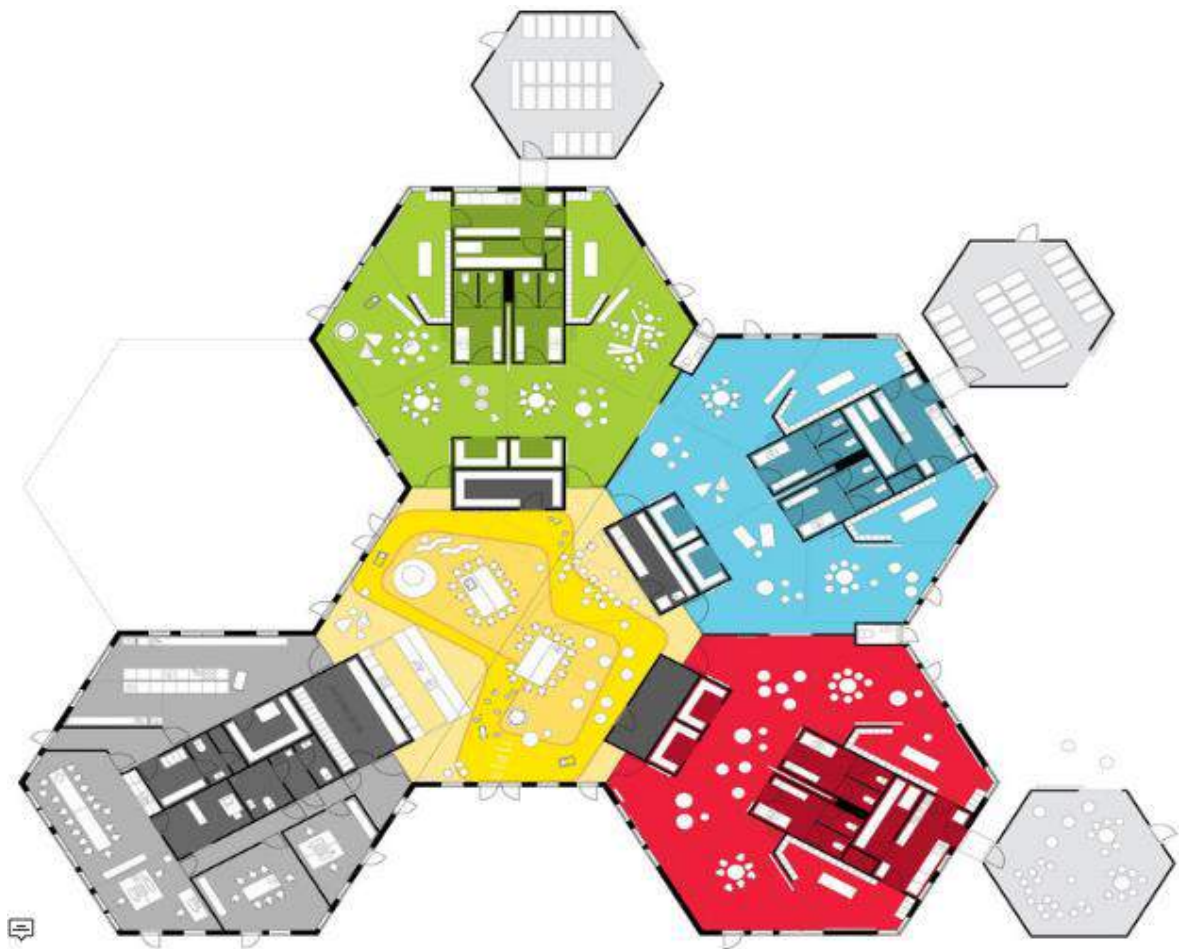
Planta baja de proyecto de Centro de Cuidados Lucinahaven
